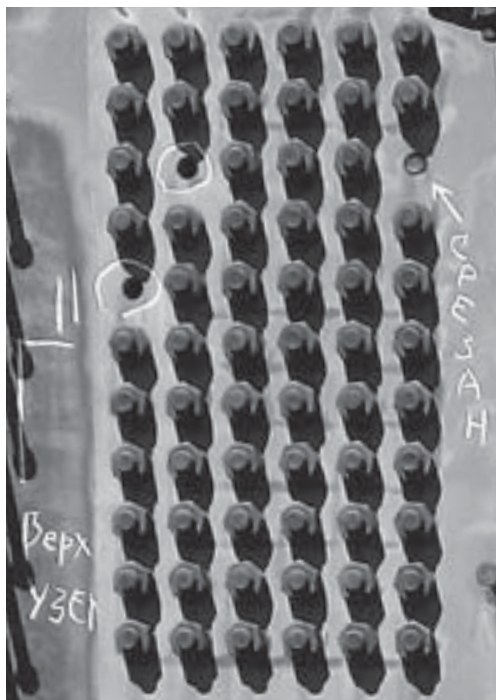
Общий вид узла 9-5В фермы 61TR-9 в месте присоединения фасонки и раскоса к узлу 9Н
